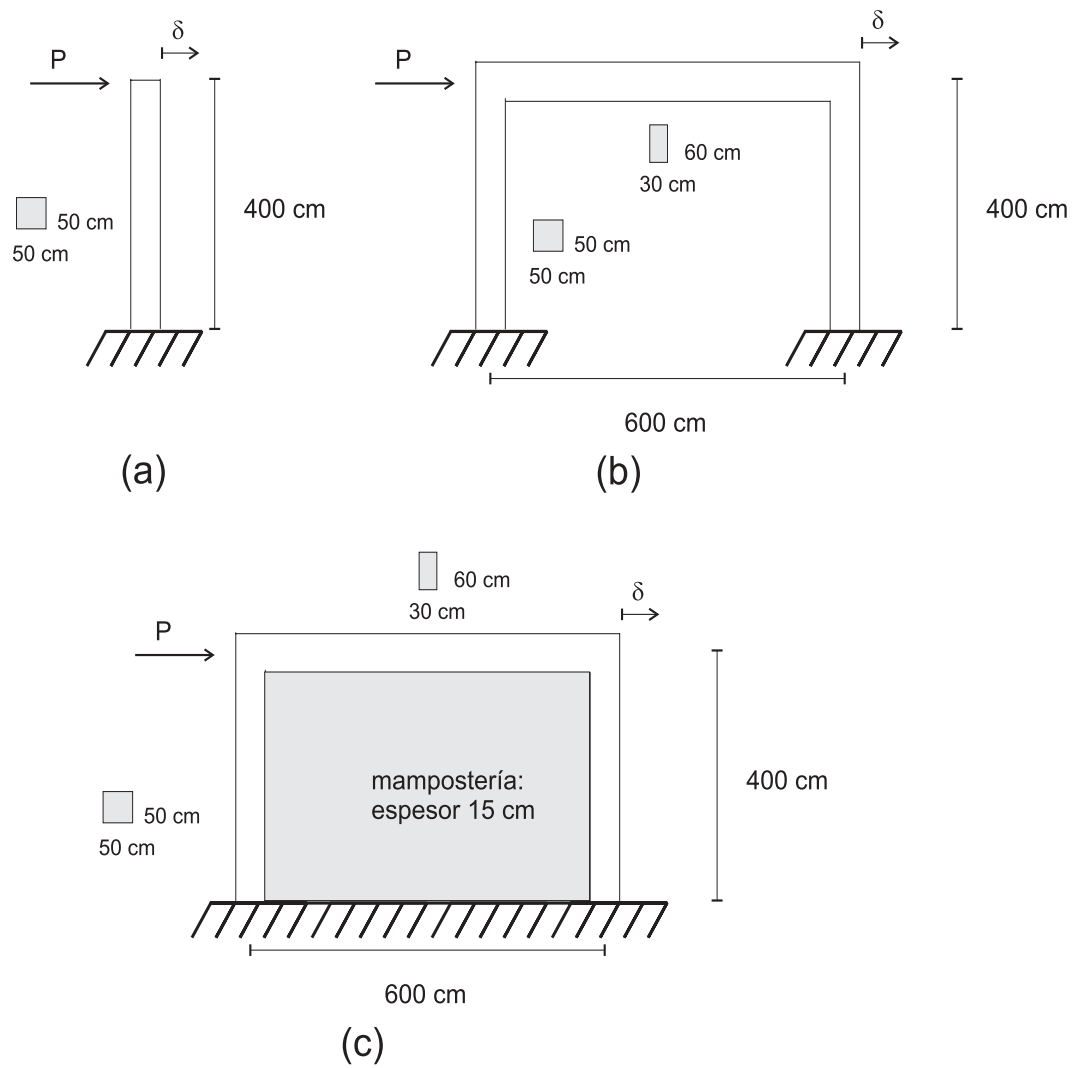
Ejemplos de rigidez de columnas de hormigón armado y muros de mampostería
